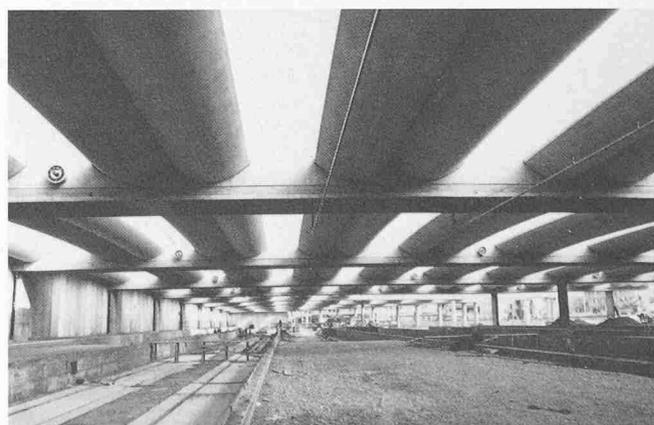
Innenansicht der Schnellgut-Halle Zürich-Altstetten
